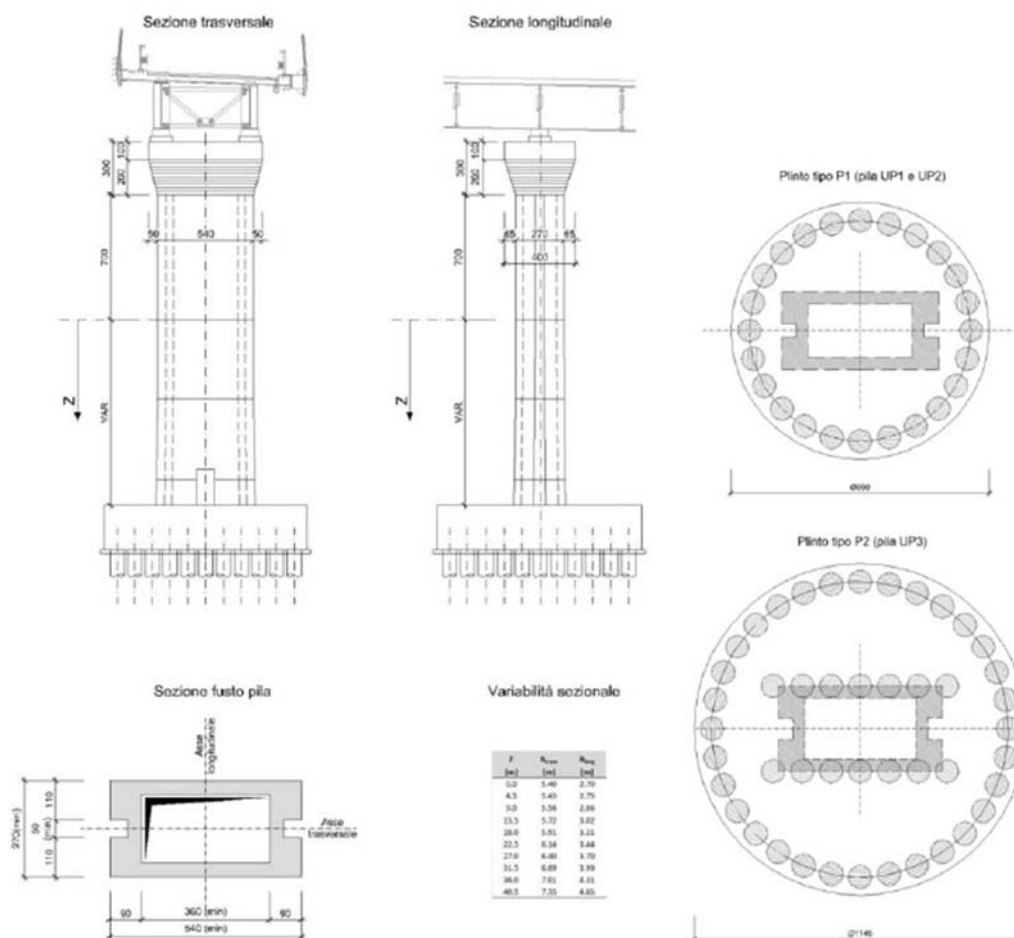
Inquadramento generale geometria pile e fondazioni Viadotto A
